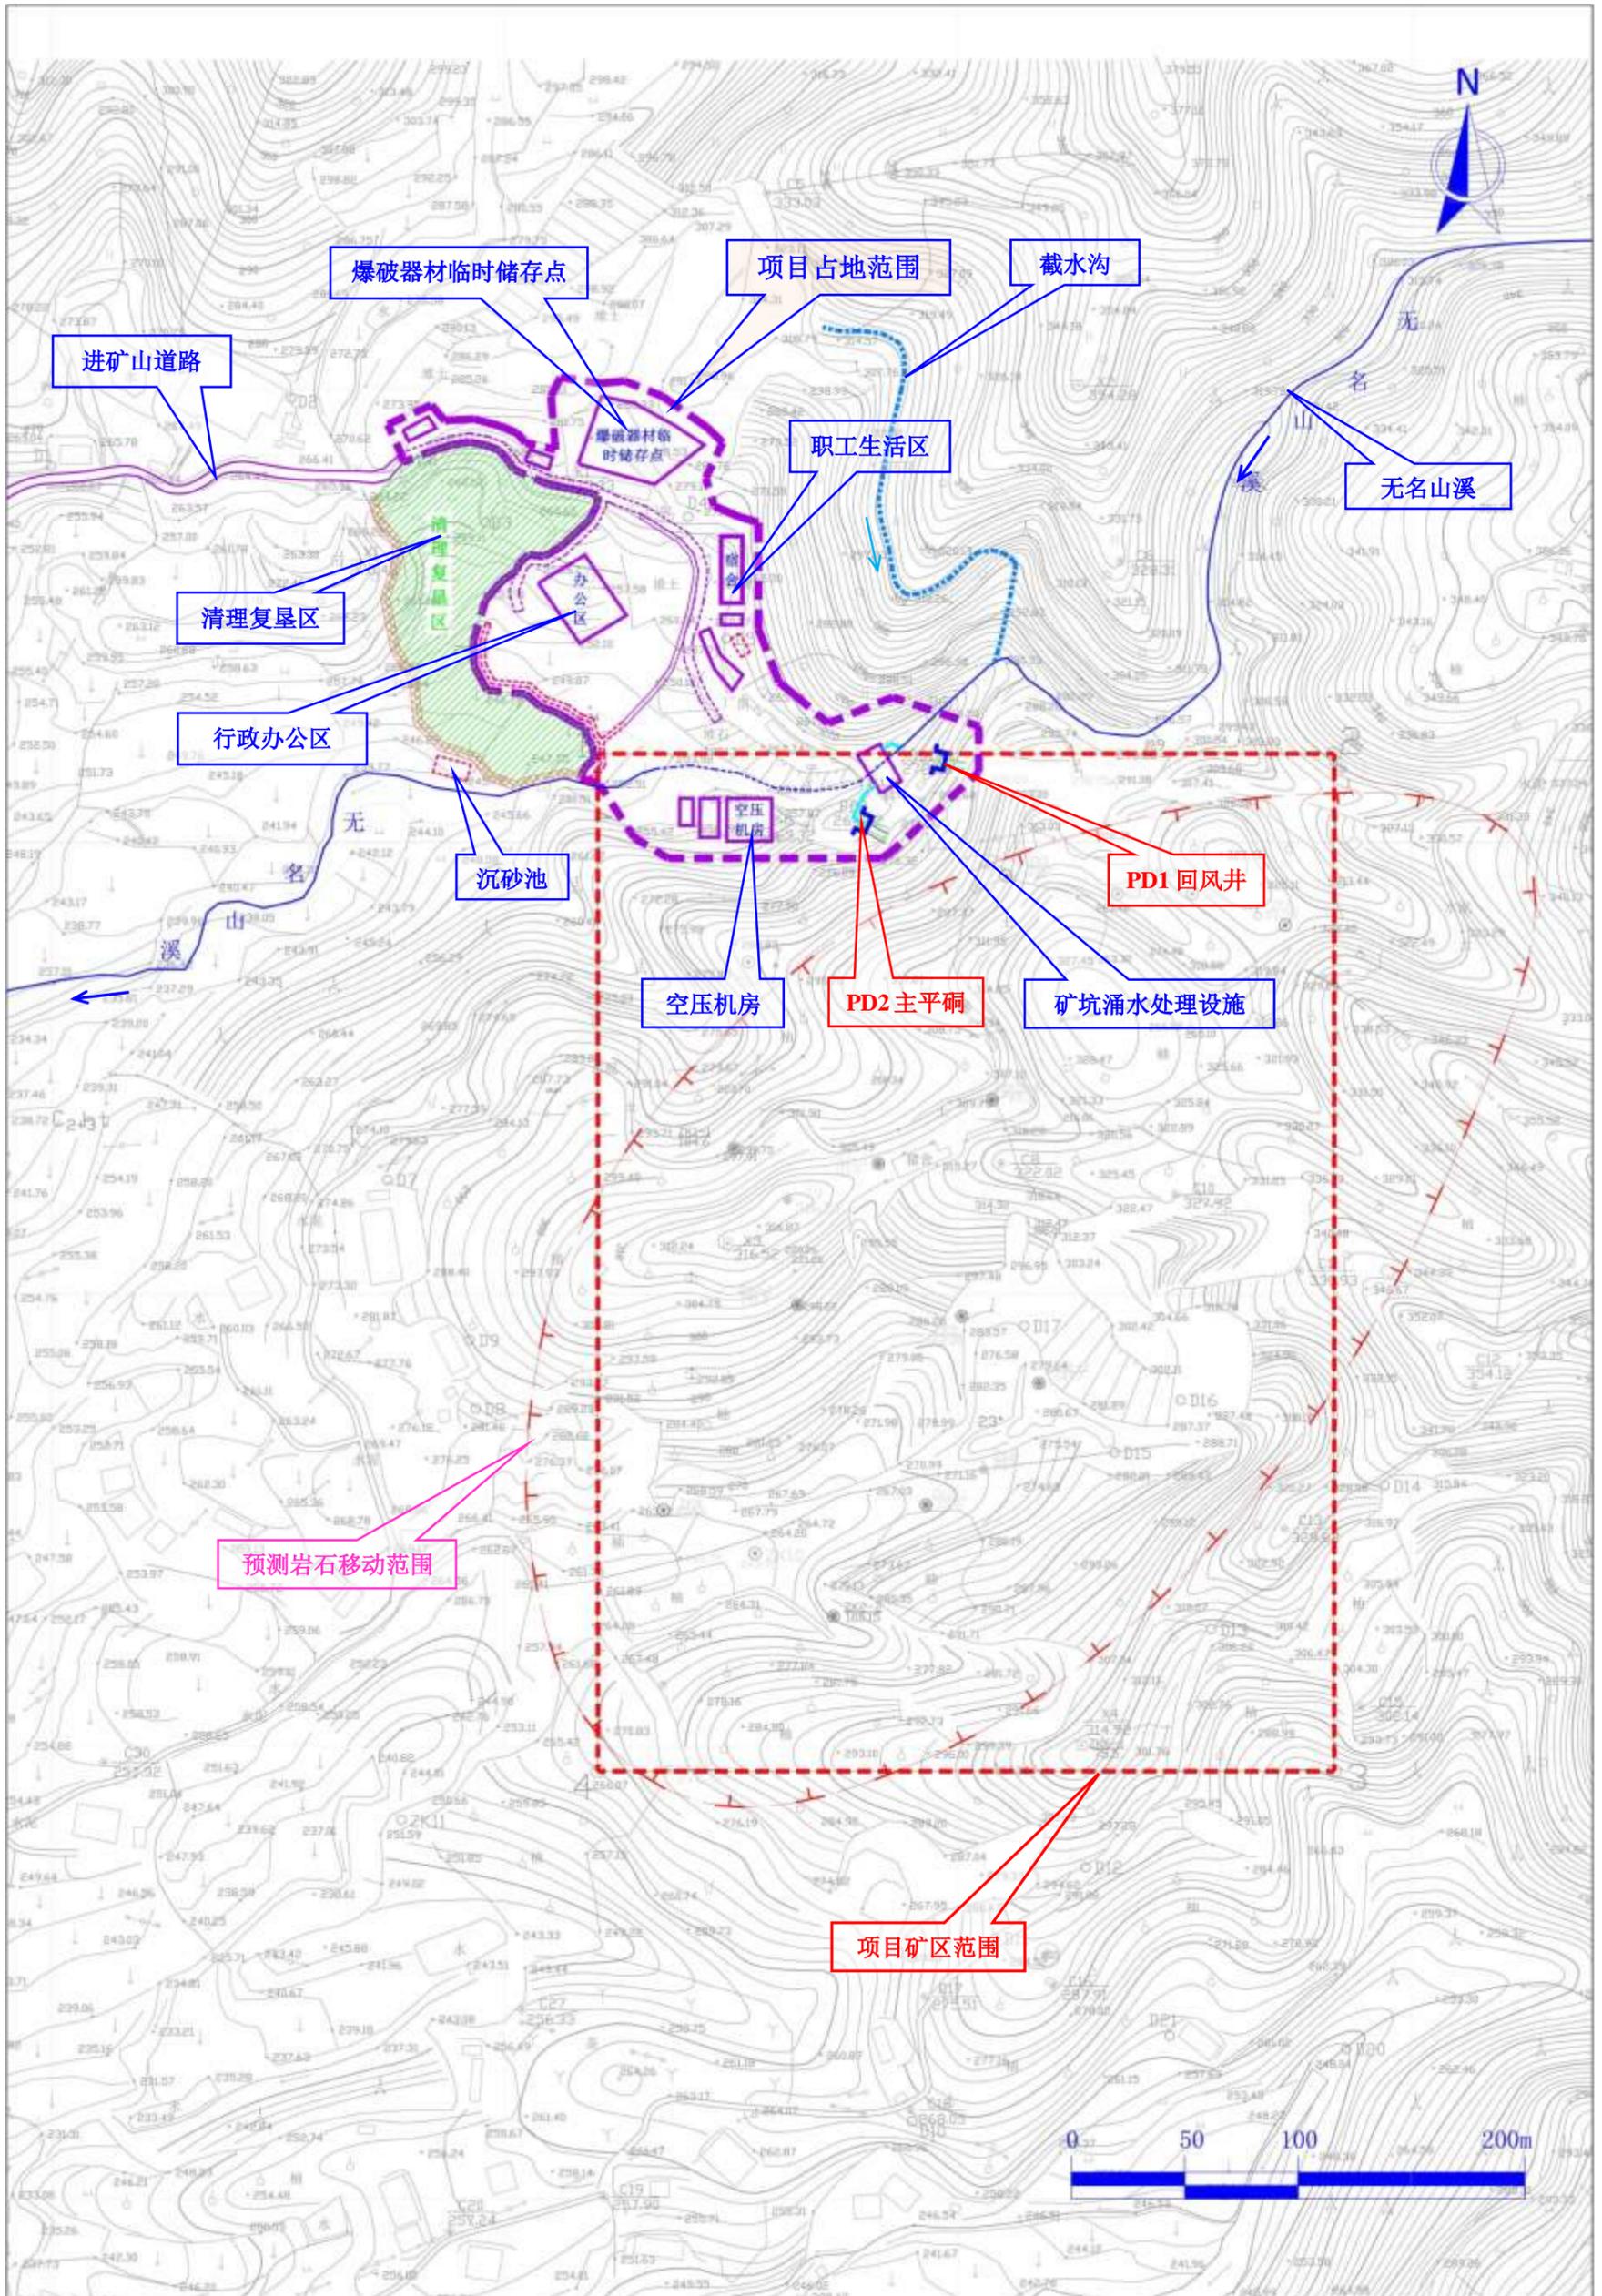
长窝里铁矿扩建工程总平面布置图
